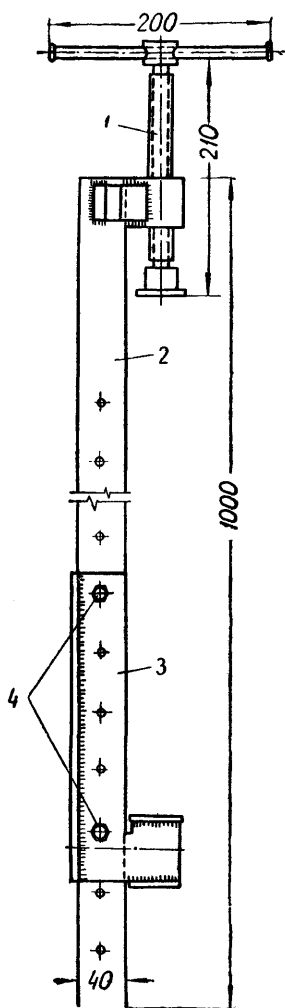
Винтовой сжим для сплачивания щитов опалубки:
